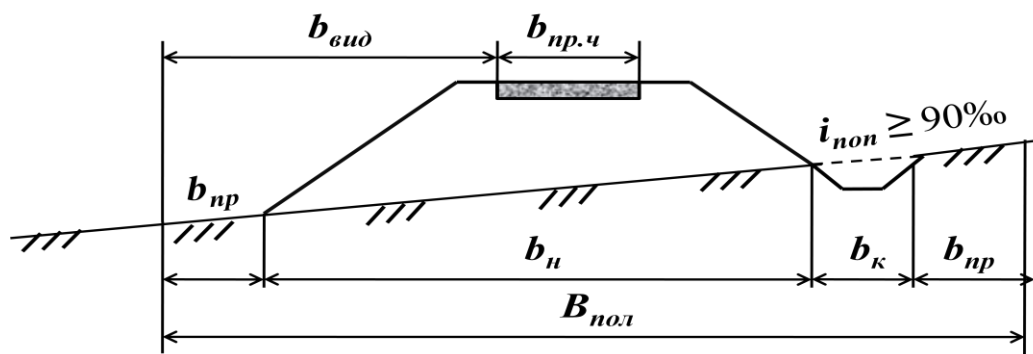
Схема к определению ширины полосы отвода для насыпей на косогоре
